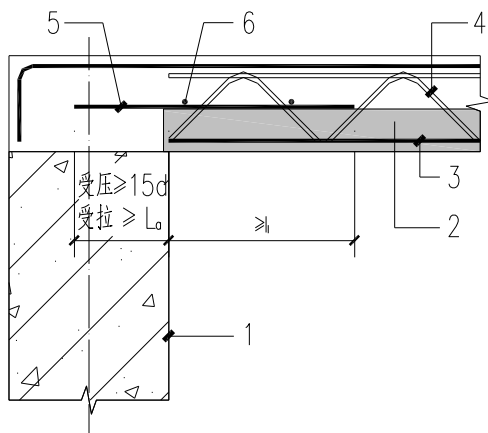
桁架钢筋混凝土叠合板端及板侧构造
